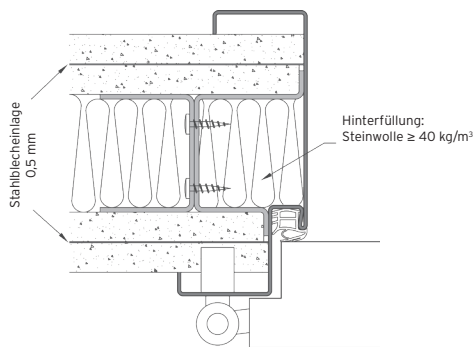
RC2-System, einbruchhemmender Wandaufbau für Stahlumfassungszarge (optional mit EI_{2,30})
